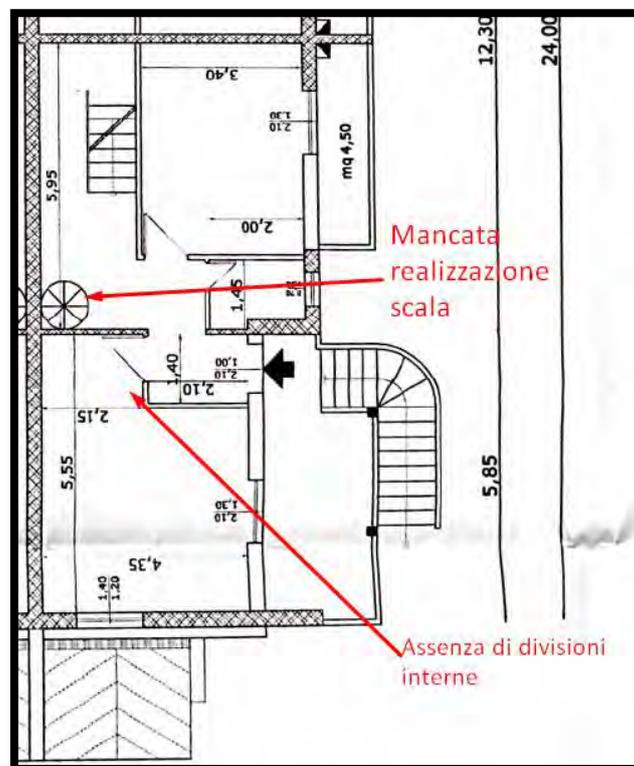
Pianta piano primo allegata alla CILA prat. n. 294/2011
